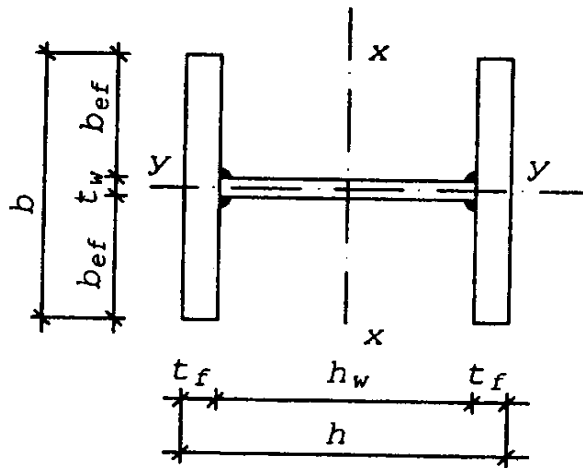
Розрахунковий переріз двотаврової колони
